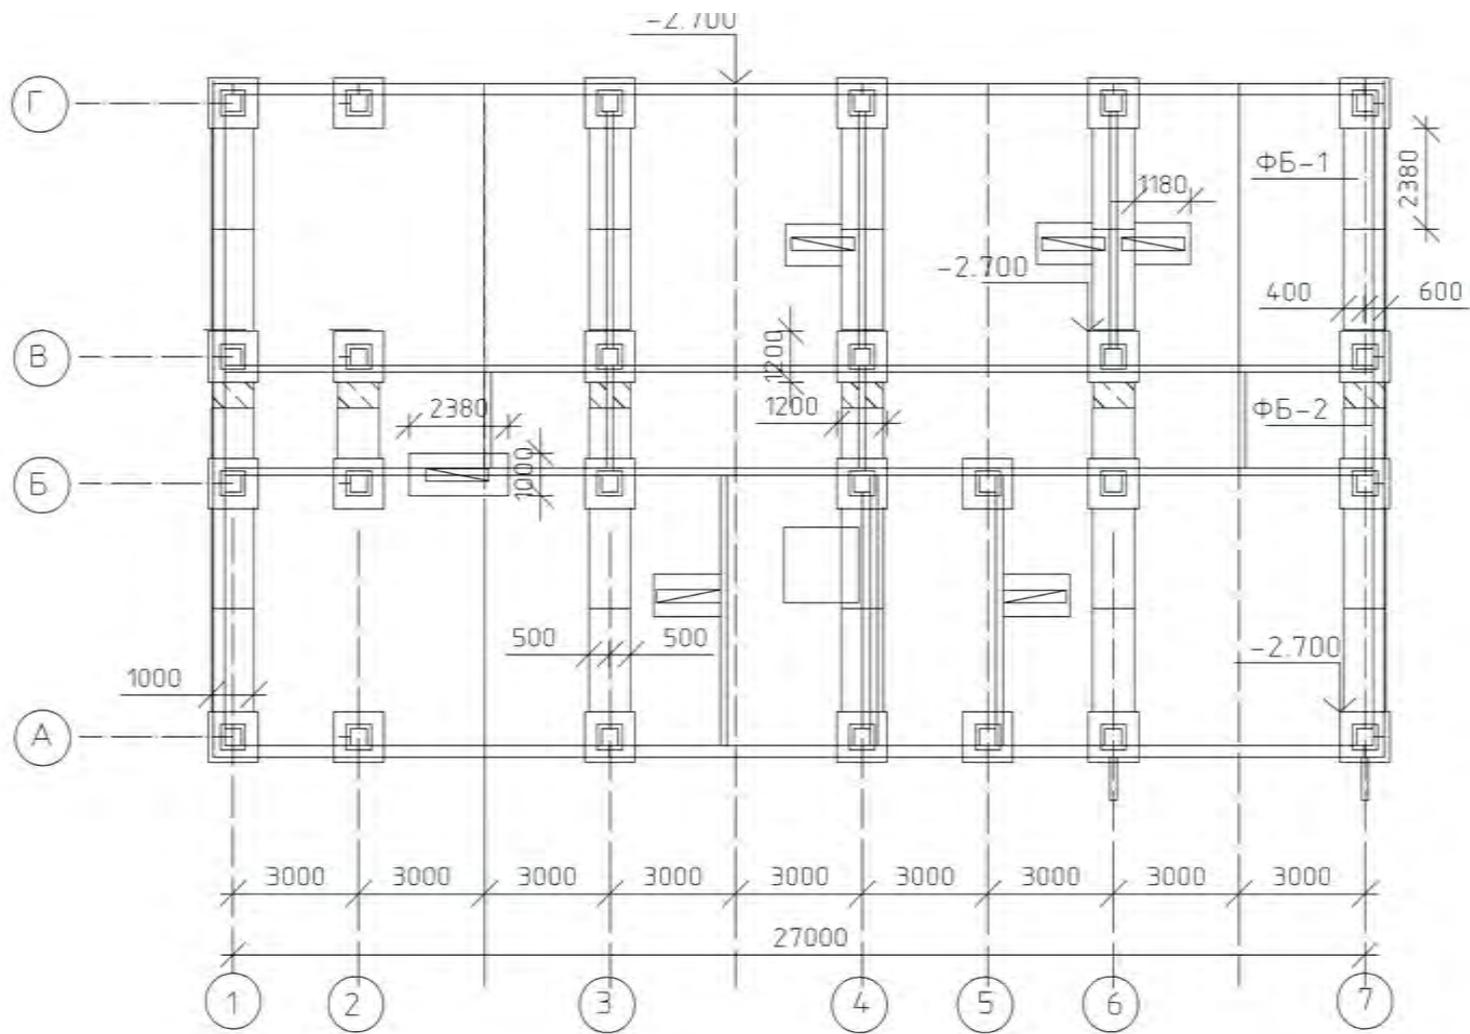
Схема расположения столбчатого фундамента для здания каркасного типа. Под стенами — ленточный сборный фундамент
